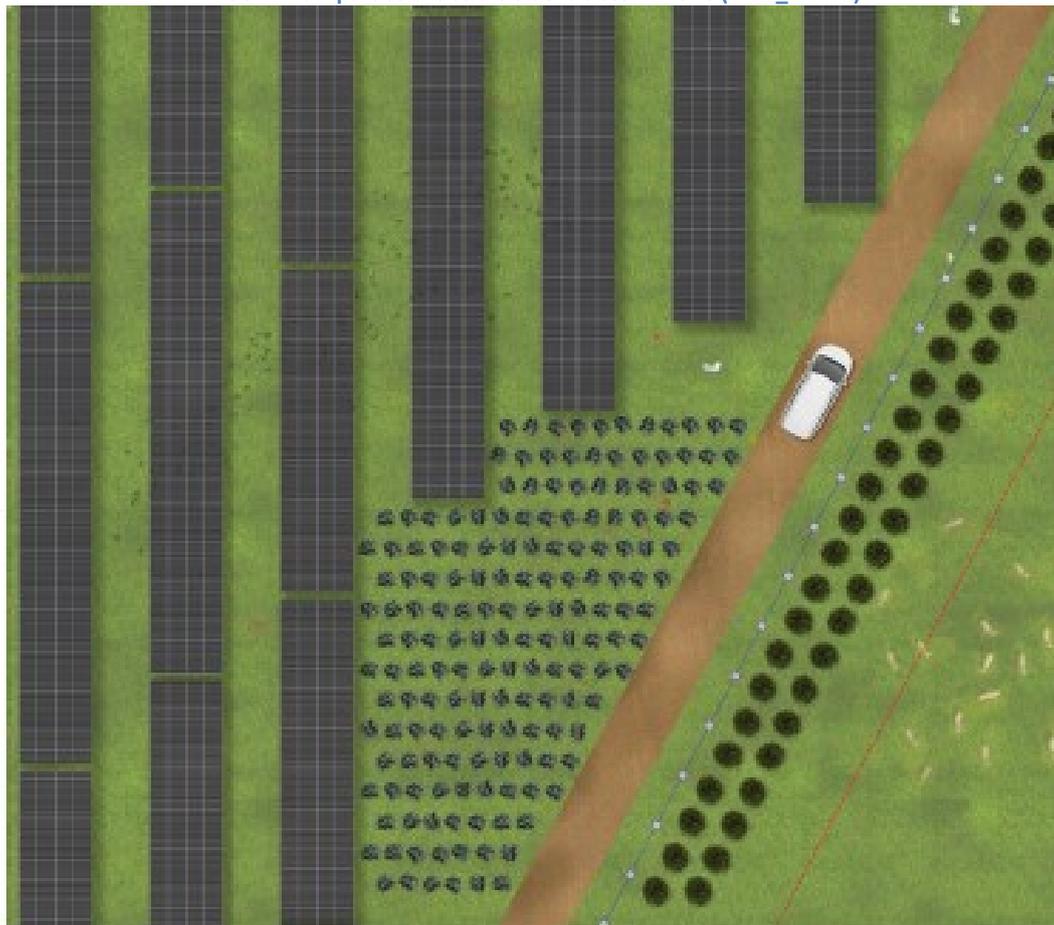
particolare stralcio della sistemazione (VIA2_TAV21)
